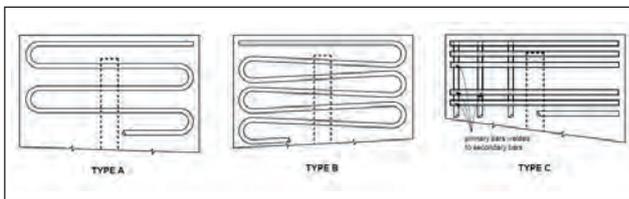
Mögliche Bewehrungsformen des britischen Modells (aus [10])
